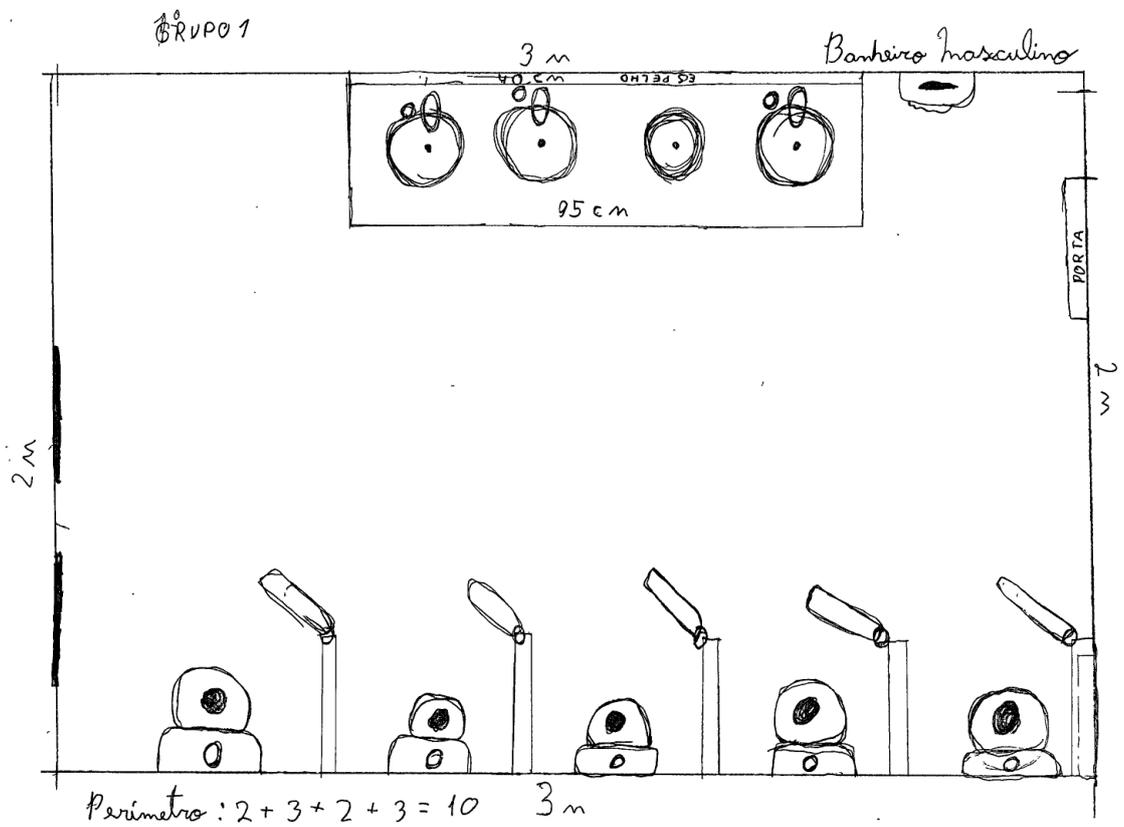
Atividade: planta baixa (6º Ano) - Acervo da autora
